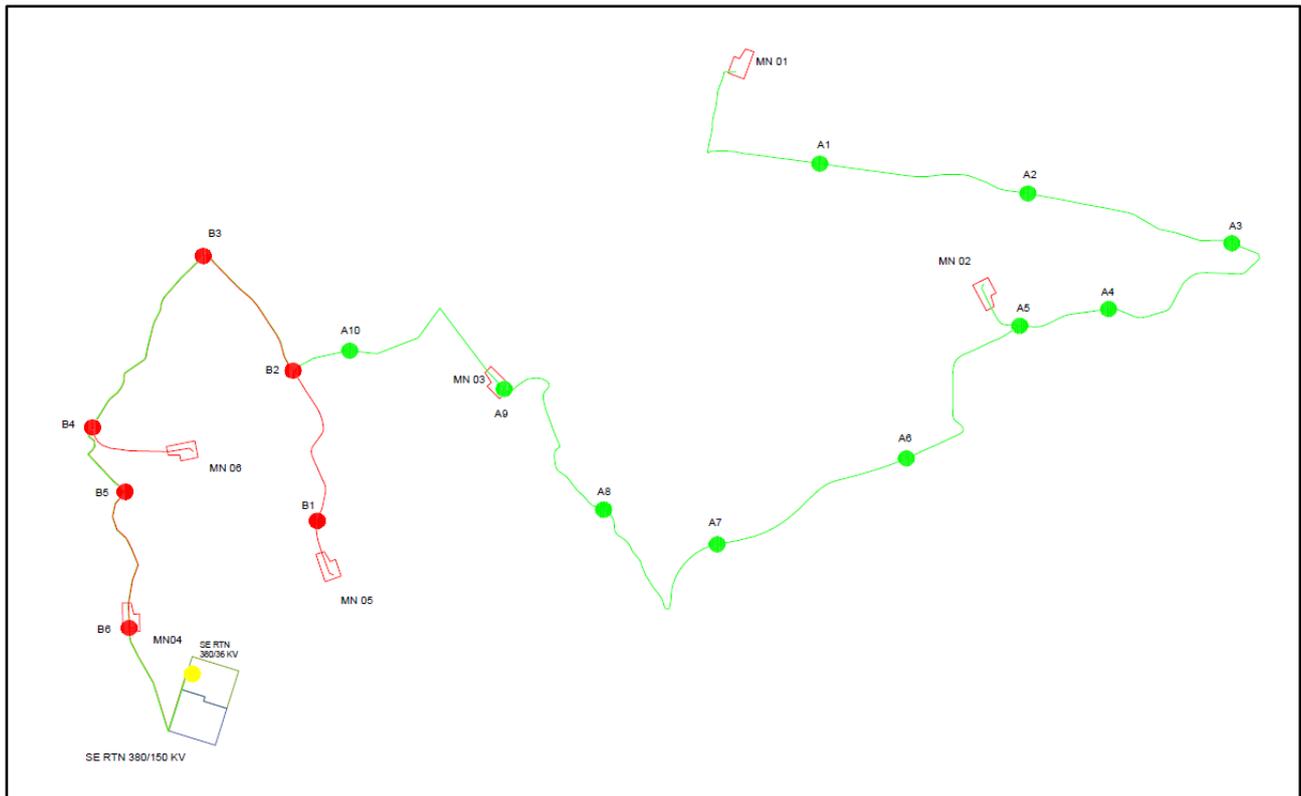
Planimetria di distribuzione linee a 36 kV dell'intero impianto
